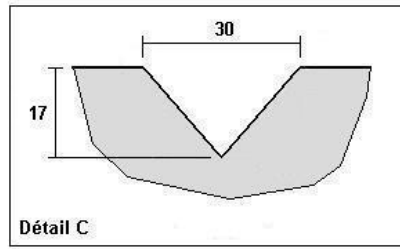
Panneaux à bossage Type 3 (dimensions en mm)
